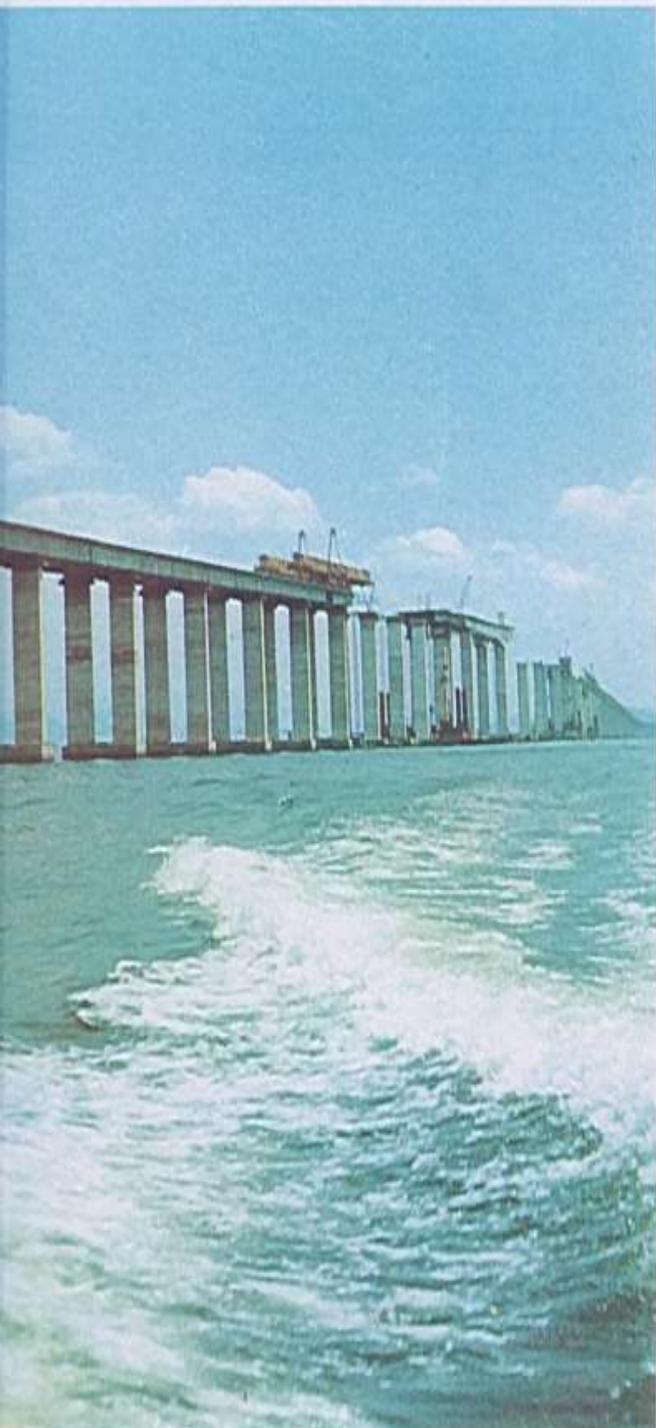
Vista frontal do escoramento de montagem, no pilar 103 lado Paquetá.
